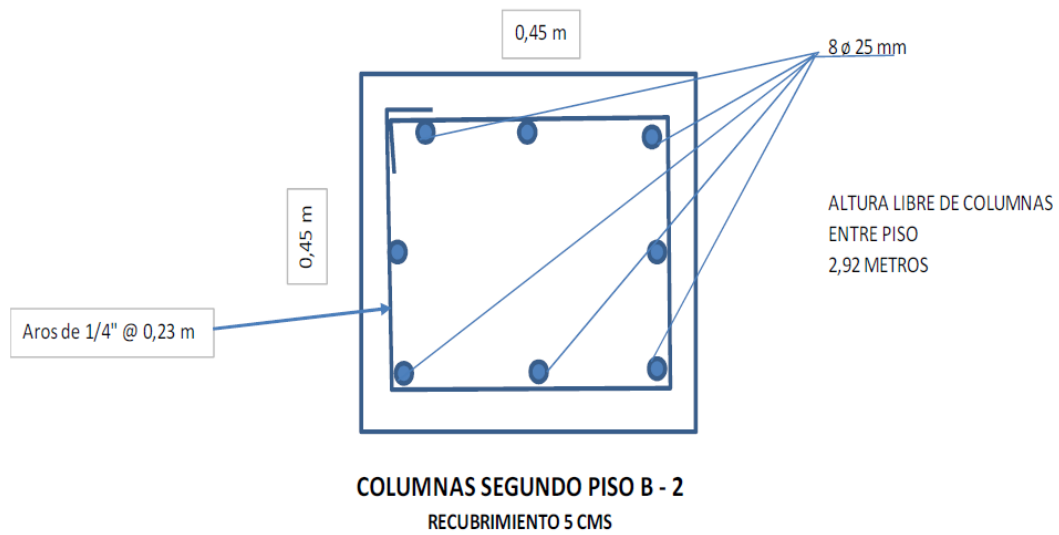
Columna B-2 Segundo Piso a Tercer Piso Edificio EPM Cartagena
